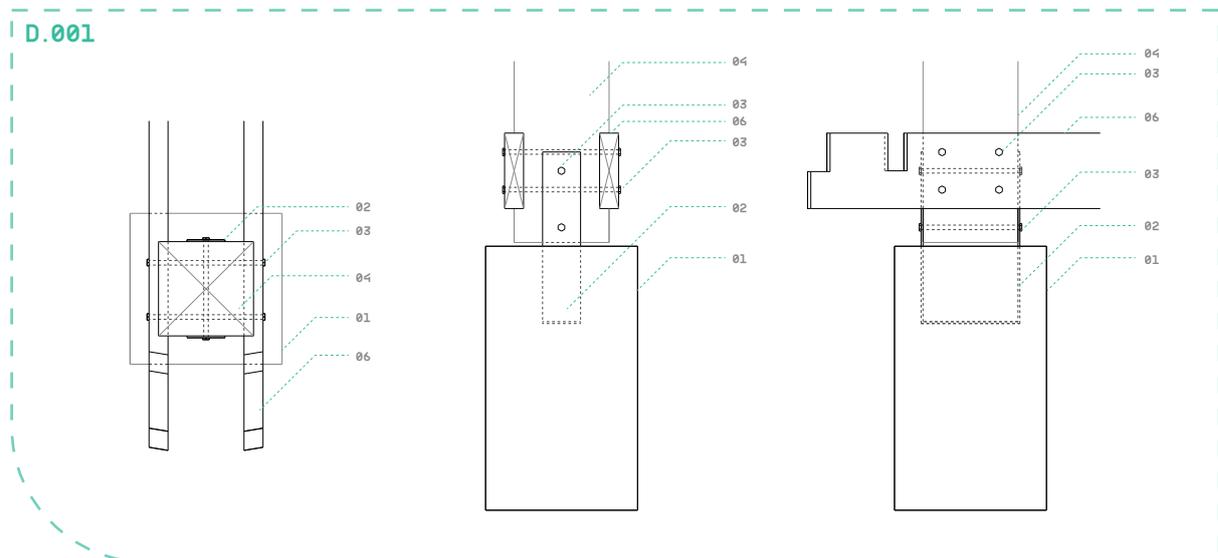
Detalle 002. Cimentación-Pilar de apoyo
